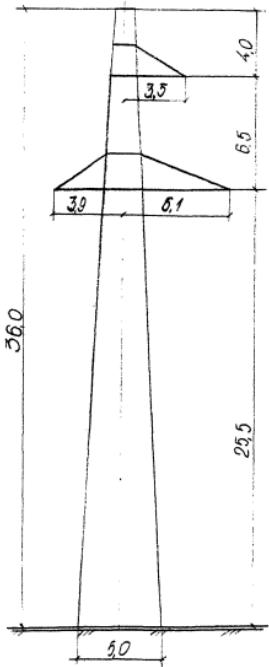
Одноцепные железобетонные опоры для ВЛ 220 кВ
